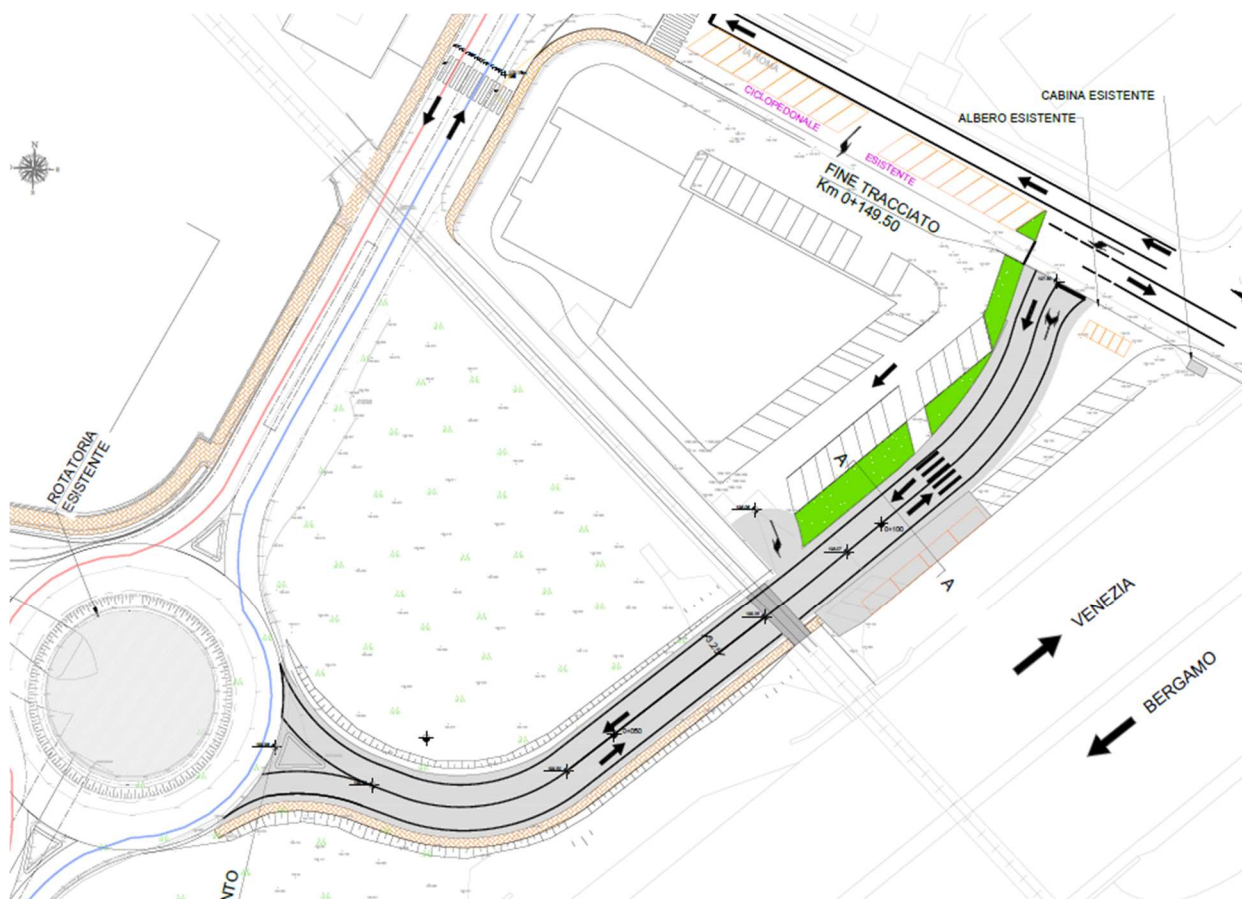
Figura 12 bretella di collegamento stradale tra la SP525 e Via Roma
